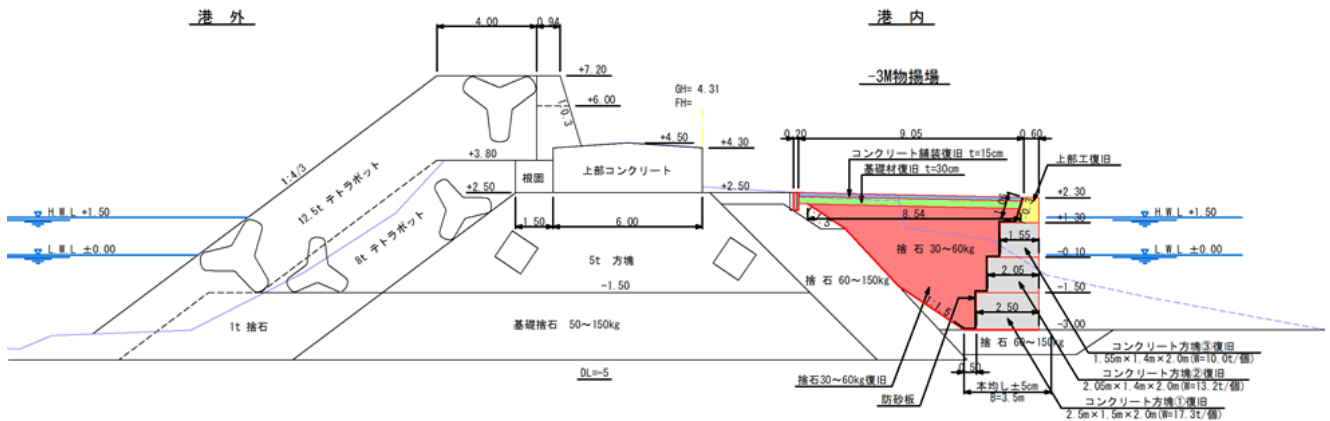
263 No.25 大洗港区\_第1埠頭地区A物揚場 (-3m) の断面図 (復旧後)
